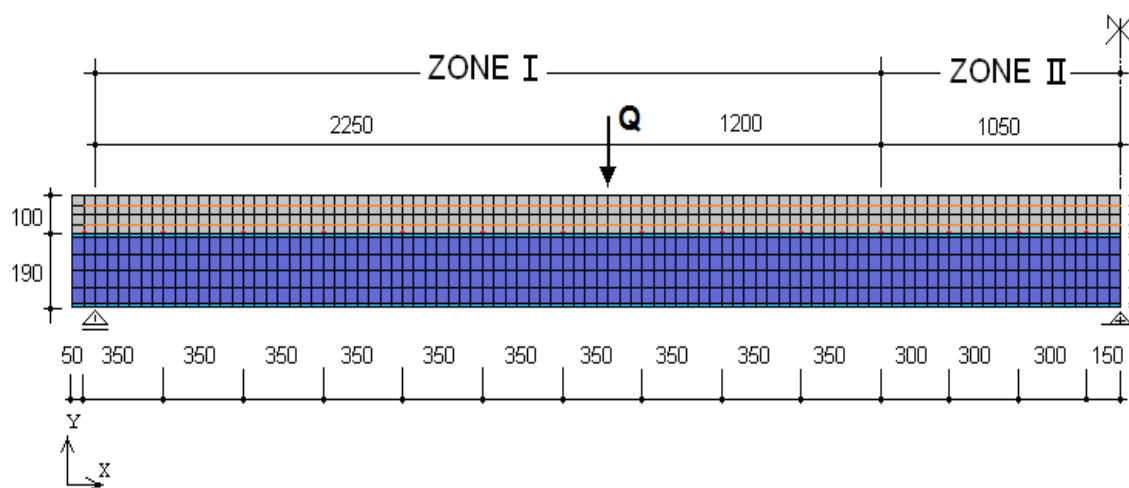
Poutre mixte continue ( CTB4 )
